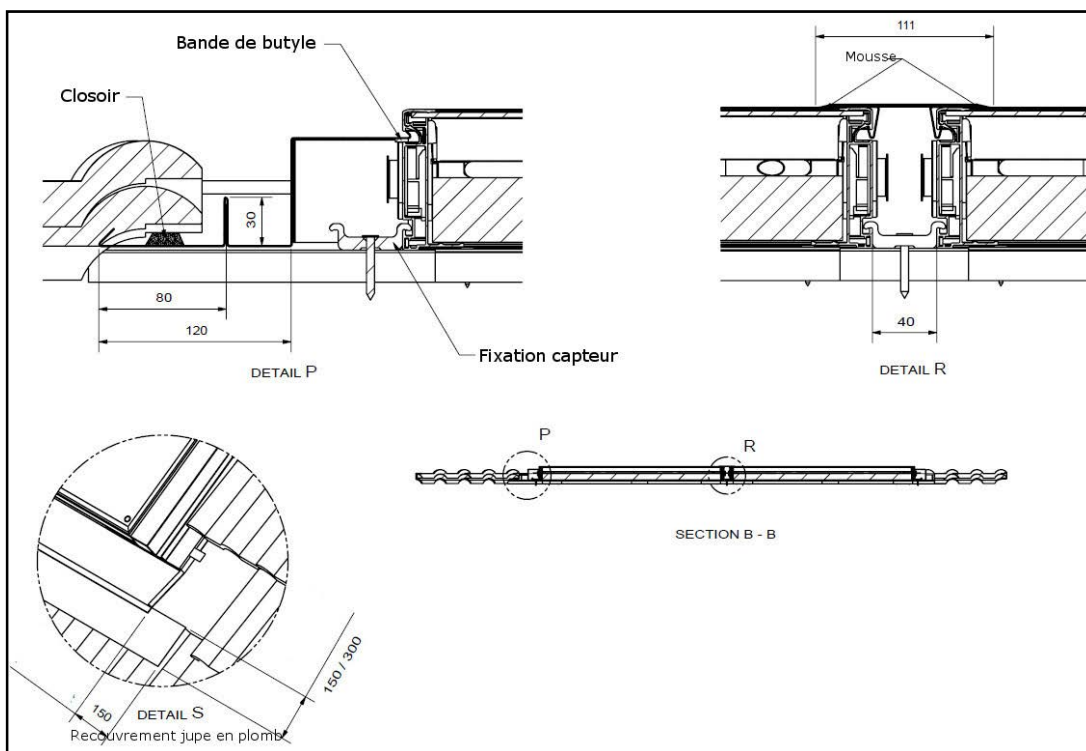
Détail en coupe du kit (suite) – Coupe BB -
